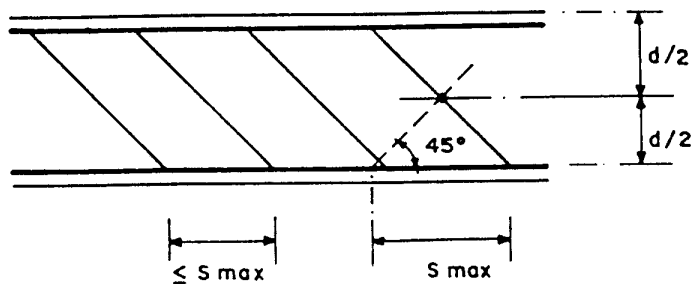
LIMITES DE SEPARACION DE LAS ARMADURAS DE CORTE
